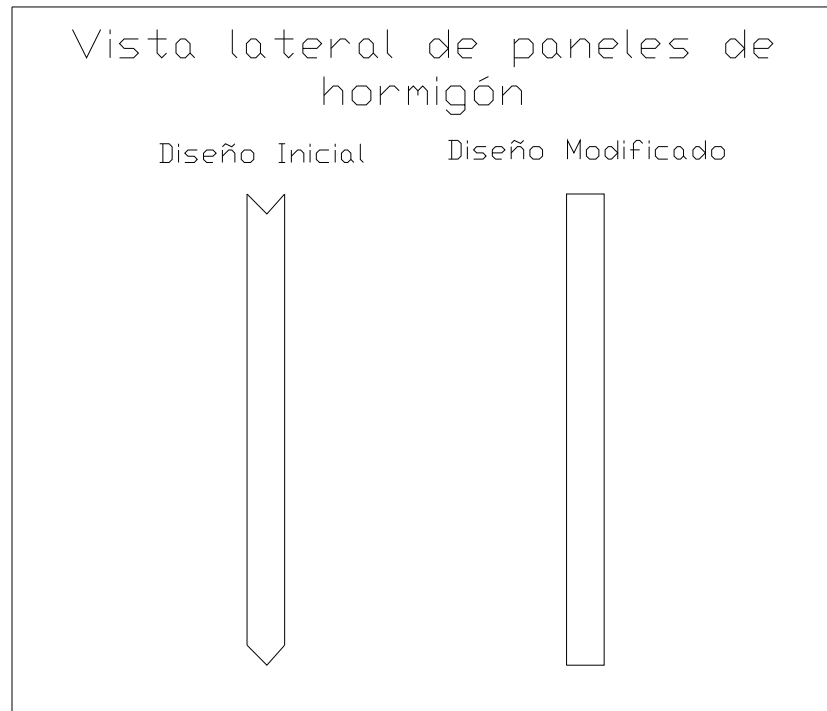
Vista lateral de diseño actual y propuesto de paneles de hormigón
